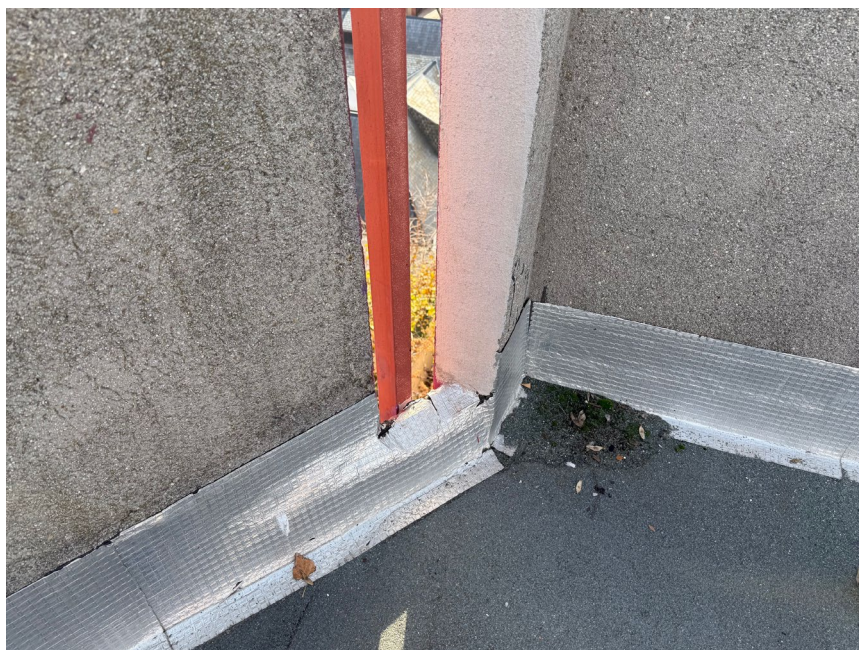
DETALLE DETERIORO IMPERMEABILIZACIÓN EN CUBIERTAS.
